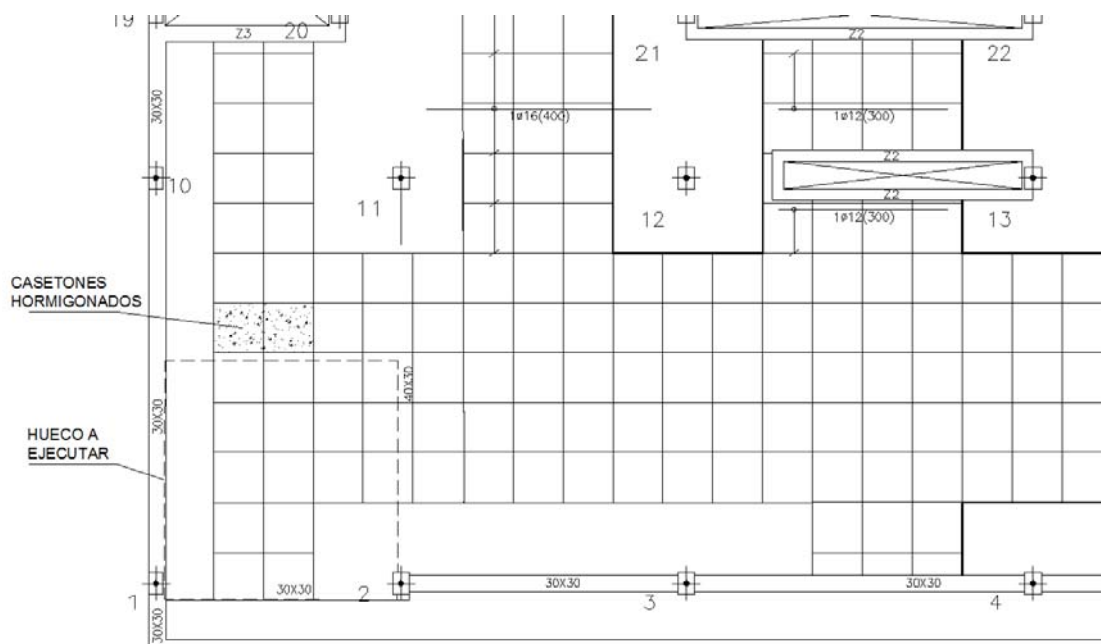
Replanteo de la estructura realizado para el presente anexo de cálculo.
